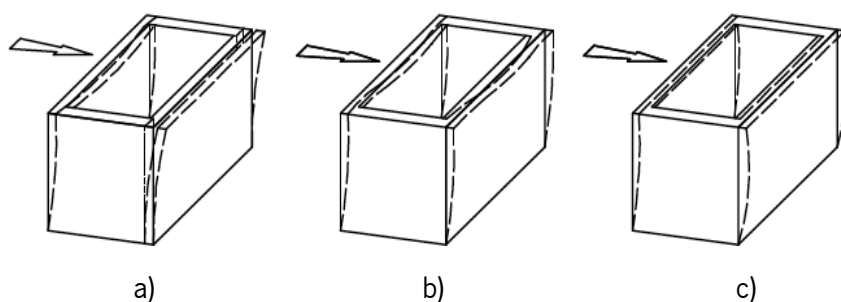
a) Edifício com pavimento de madeira e fraca ligação entre os elementos verticais; b) Edifício com adequada ligação entre as paredes, mas com pavimento de madeira; c) Edifício com adequada ligação entre os elementos estruturais e com o pavimento rígido (Vasconcelos, 2005).
